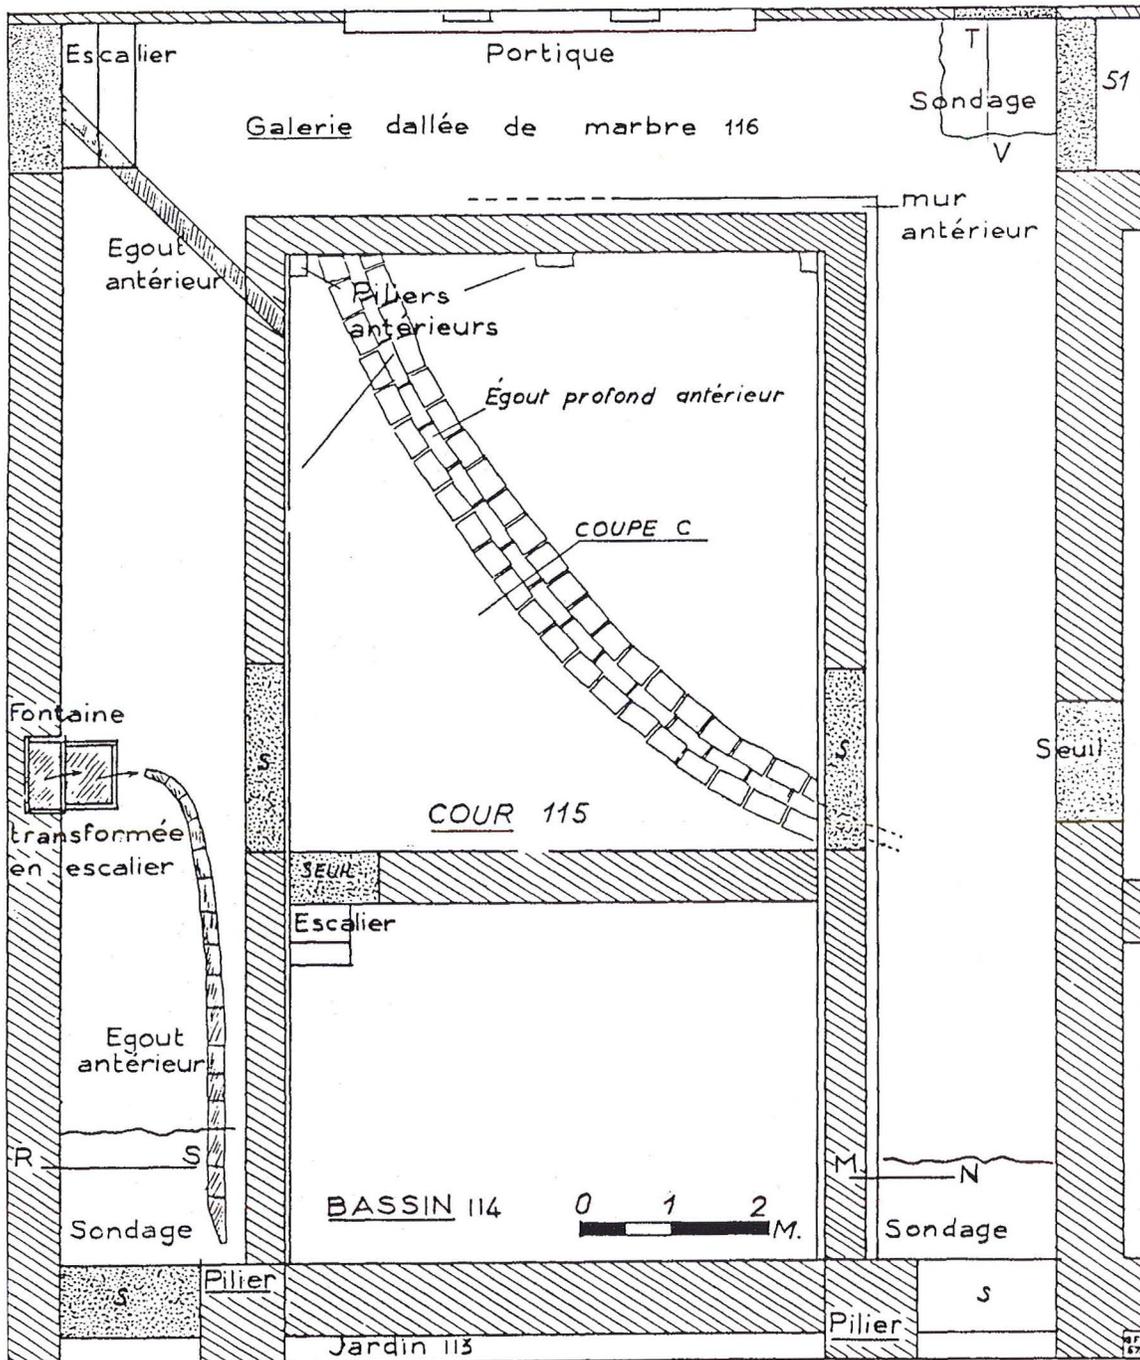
Plan du péristyle par G. Fouet (Fouet, 1969, 80).
